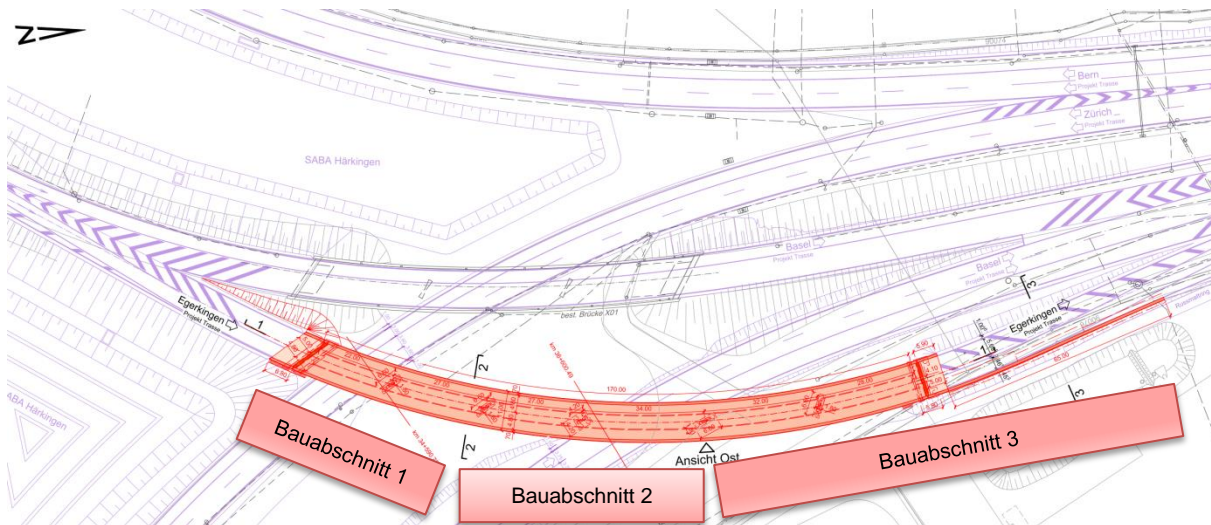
Situation neue Brücke Rampe Egerkingen
